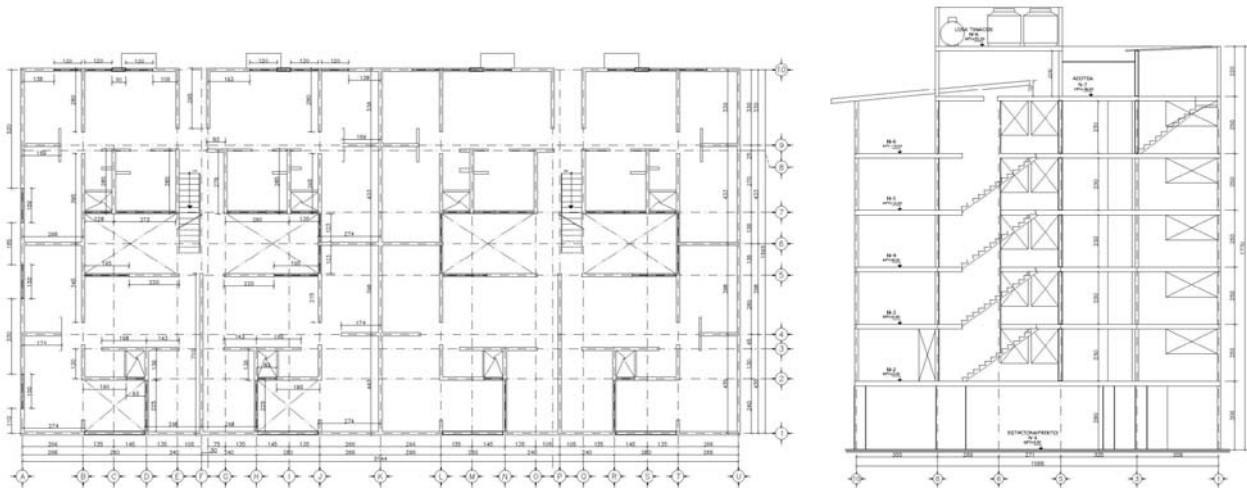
, PROPIEDADES PLANTA DE NIVEL 2 Y CORTE EN EJE P
